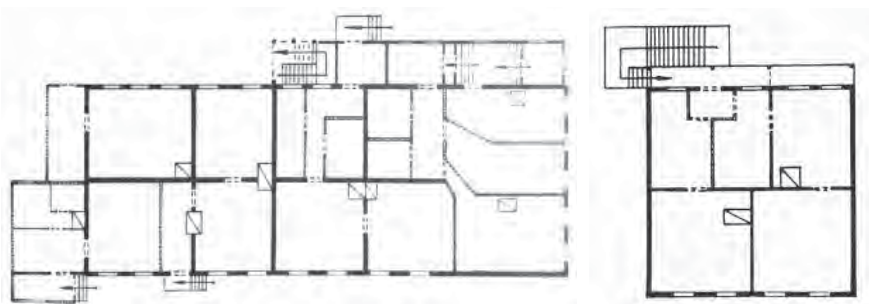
План 1 этажа главного здания усадьбы Тенишевых. План мезонина (КОПИК ПО)
